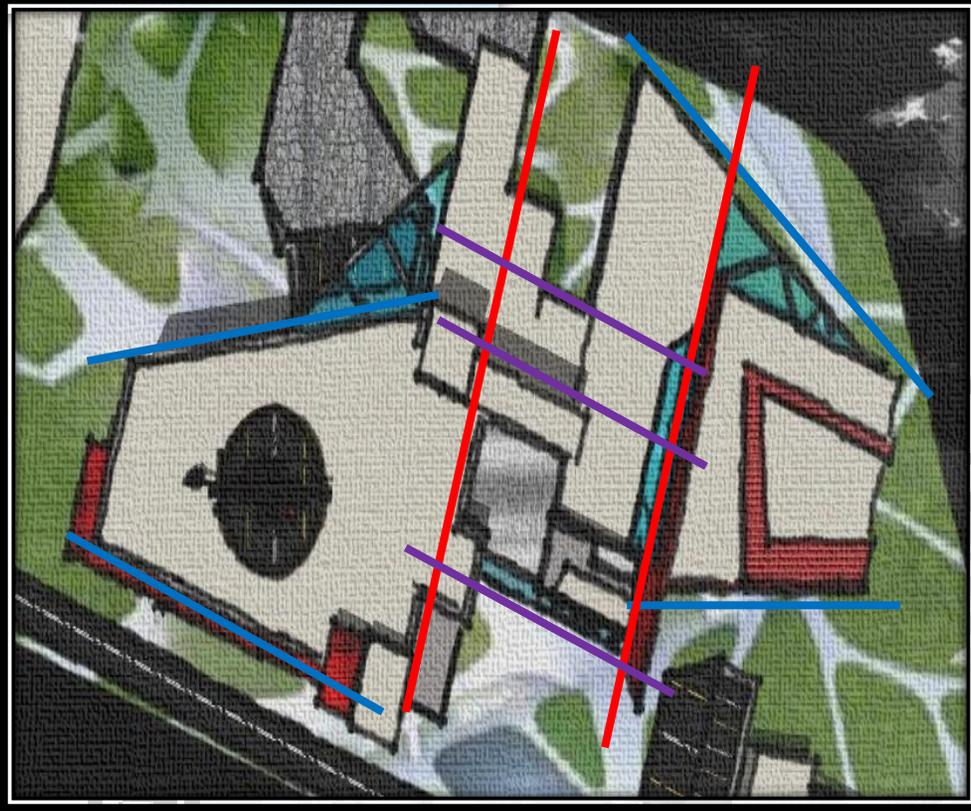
Distribución de Módulos en Planta.---Elaboración Propia
